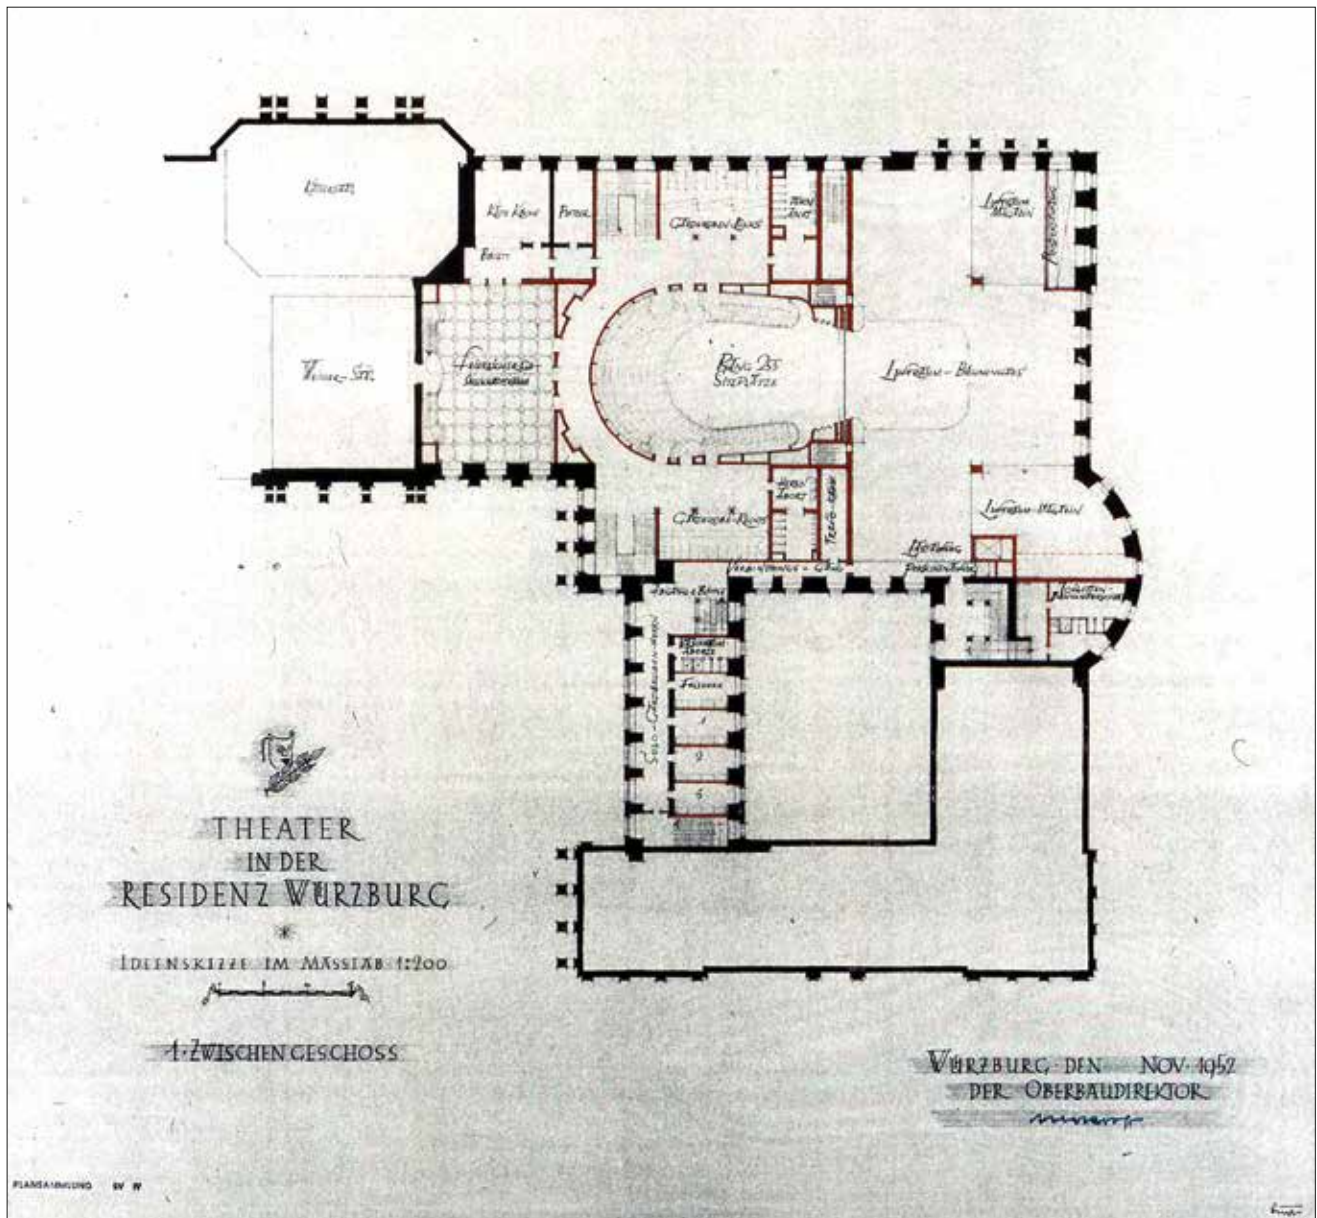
Nicht ausgeführter Entwurf eines Theaters in der Residenz Würzburg, 1952, Grundriss 1. Zwischengeschoss (Plansammlung der Bauabteilung BSV München)
